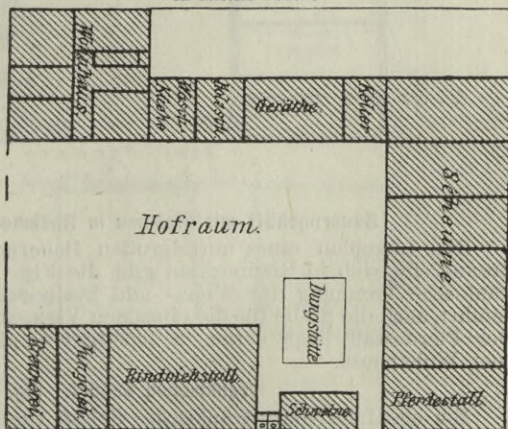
Bauerngehöft mit Weinbau und Brennereibetrieb in Rheinhessen.
